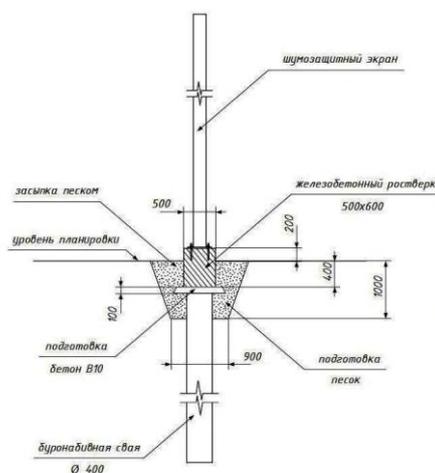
Железобетонный ростверк на буронабивных сваях
